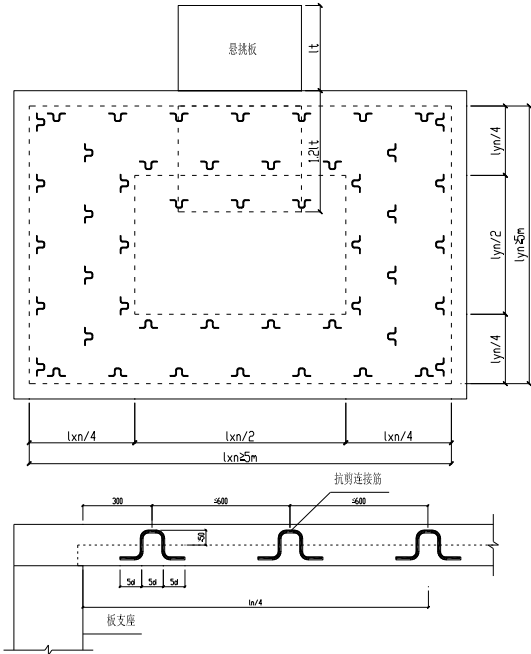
叠合板界面抗剪连接钢筋构造要求
